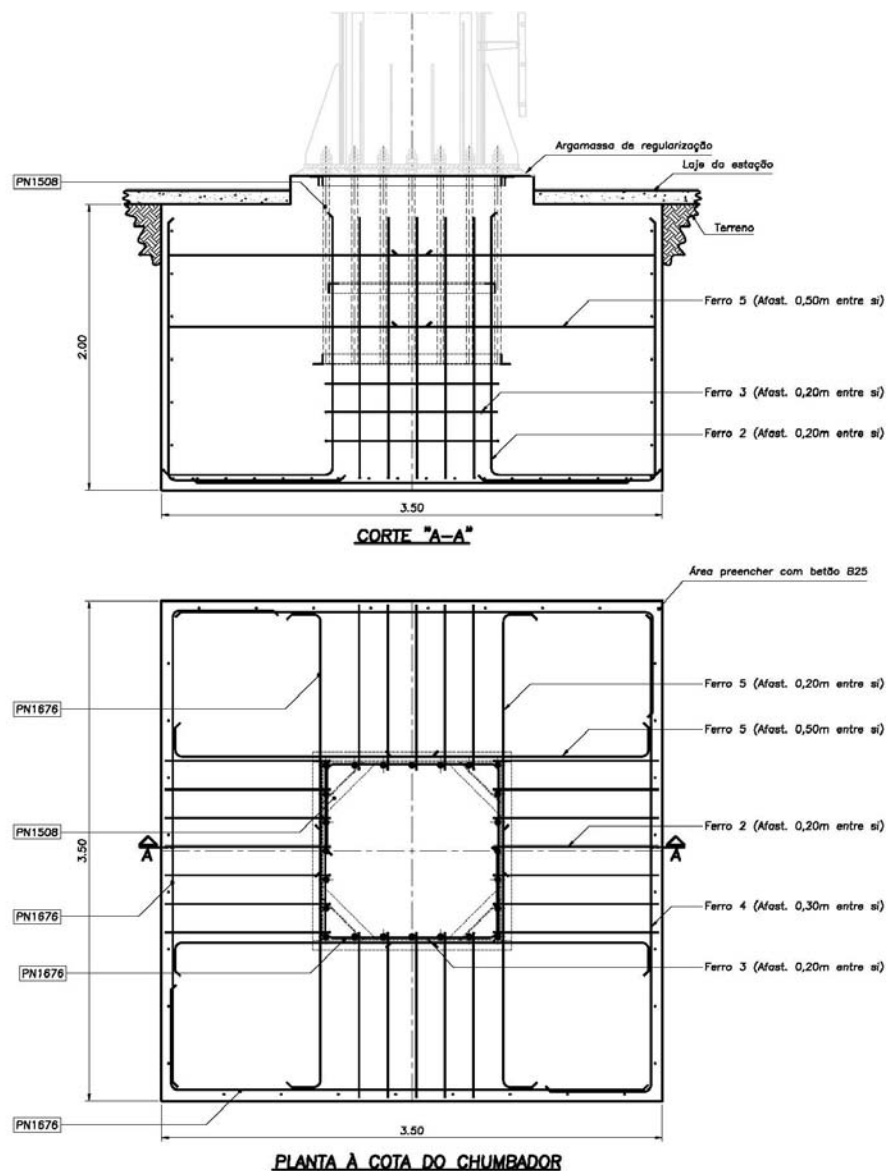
Fundação de Poste-Árvore\_Esquema de montagem armadura/chumbador
